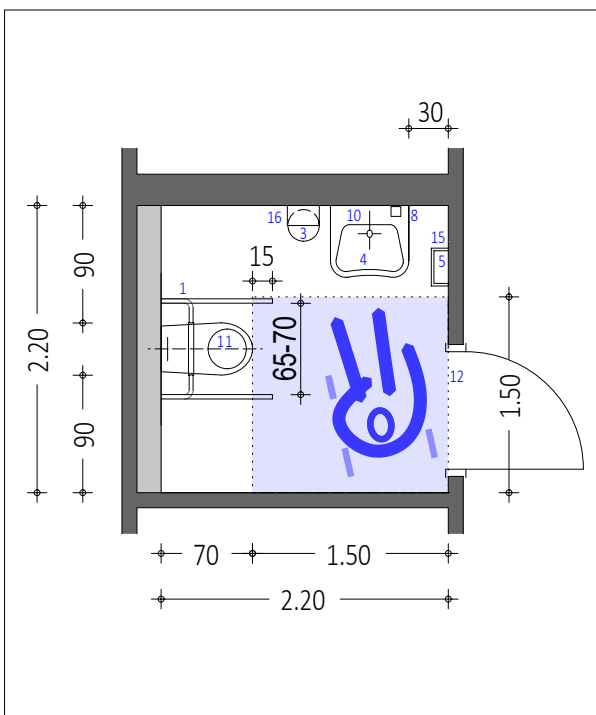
WC-Grundriss - Mindestabmessungen und Bewegungsflächen I
